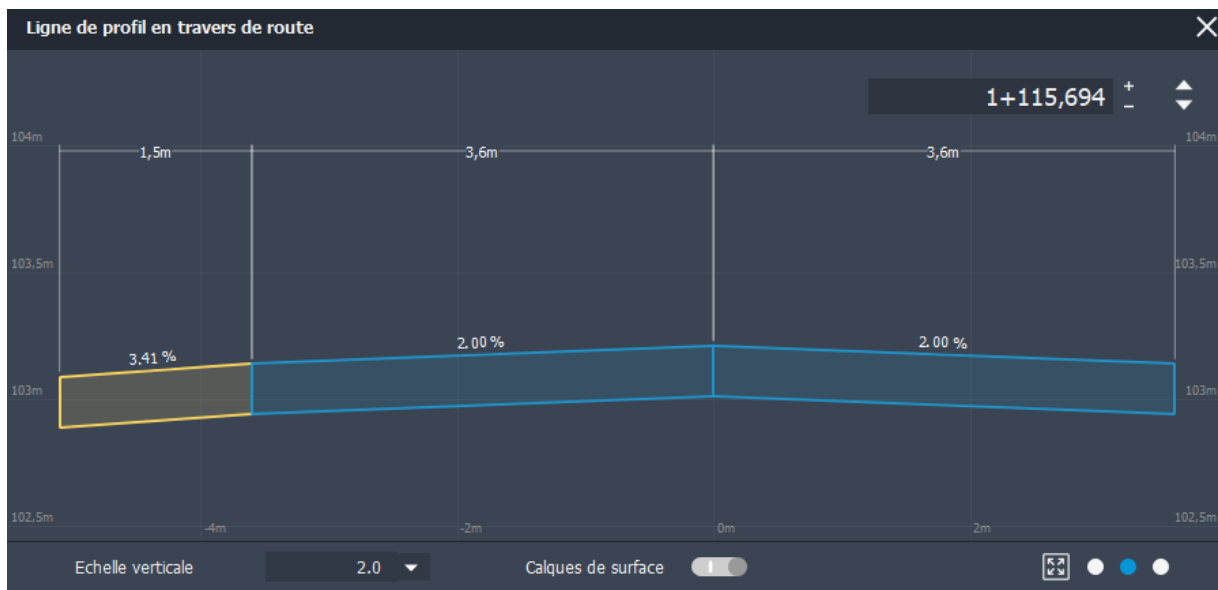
Profile en travers de variante V1 sur l'infraworks.
